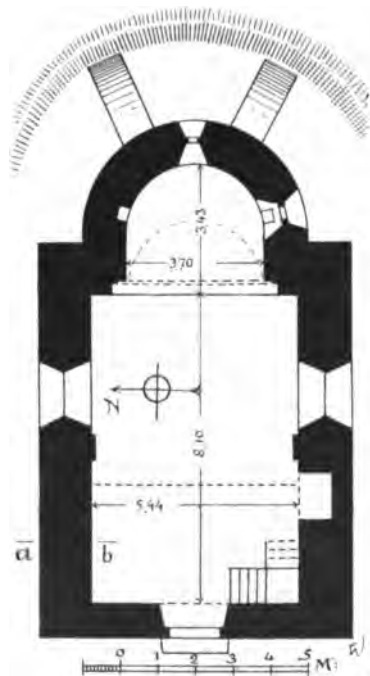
Schrotzhofen. Grundriß der Kirche.
